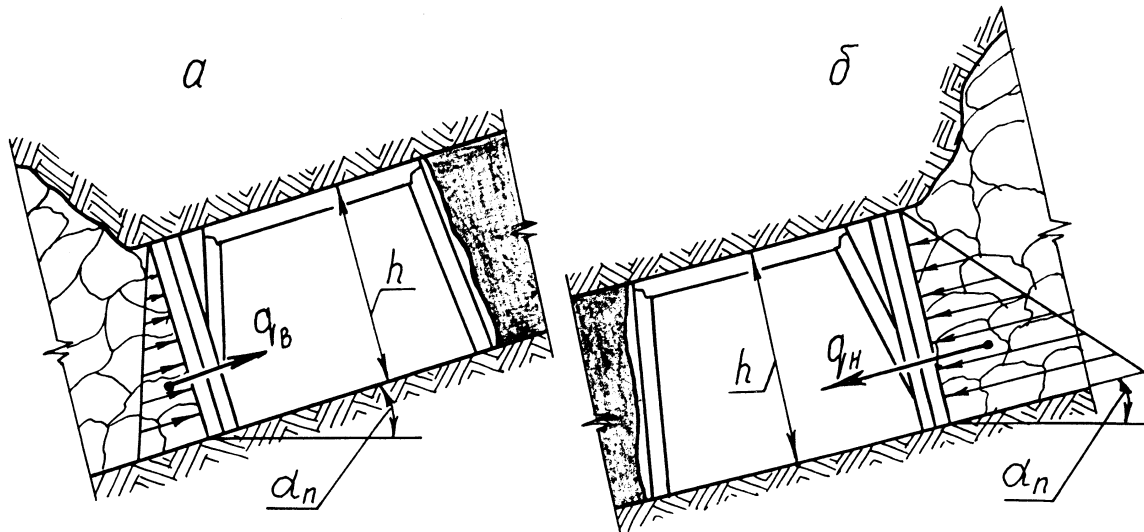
Схемы к расчету боковой нагрузки на крепь сохраняемой подготовительной выработки: а – восходящий порядок отработки; б – нисходящий
